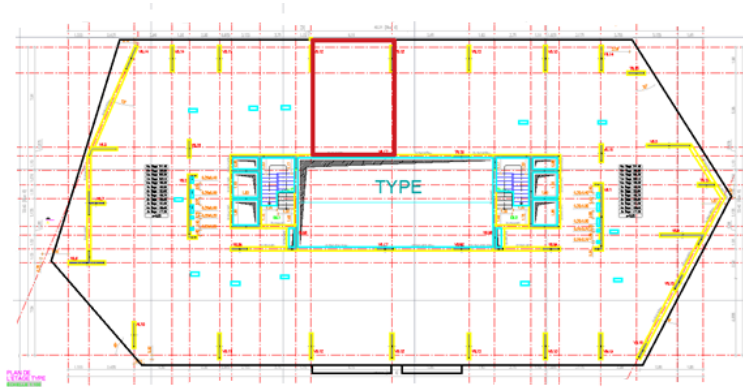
Disposition du panneau choisi pour pré-dimensionnement de la dalle.
